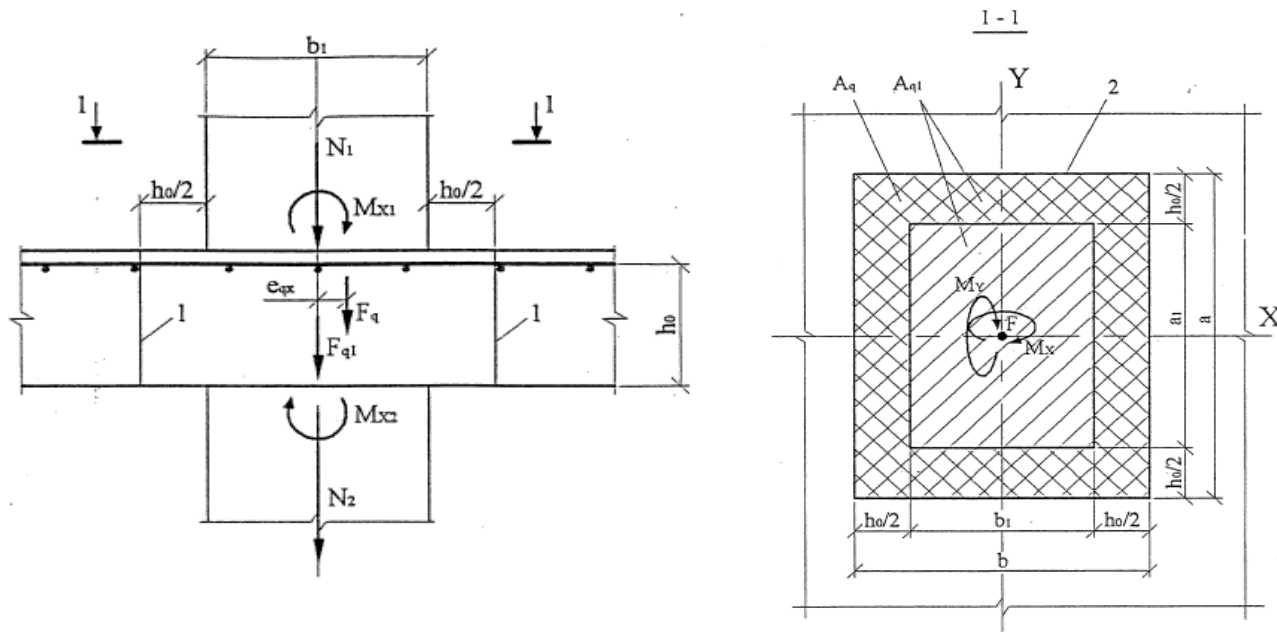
Расчетные схемы к расчету плиты перекрытия на продавливание.
